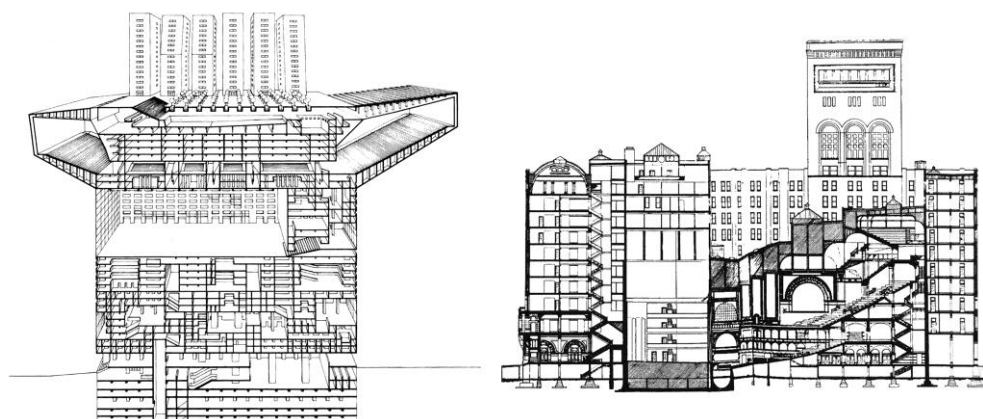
Secciones. a) Atlapole, Hans Kollhoff, 1988. b) Auditorium Building, Chicago, Adler y Sullivan, 1887-1889.
